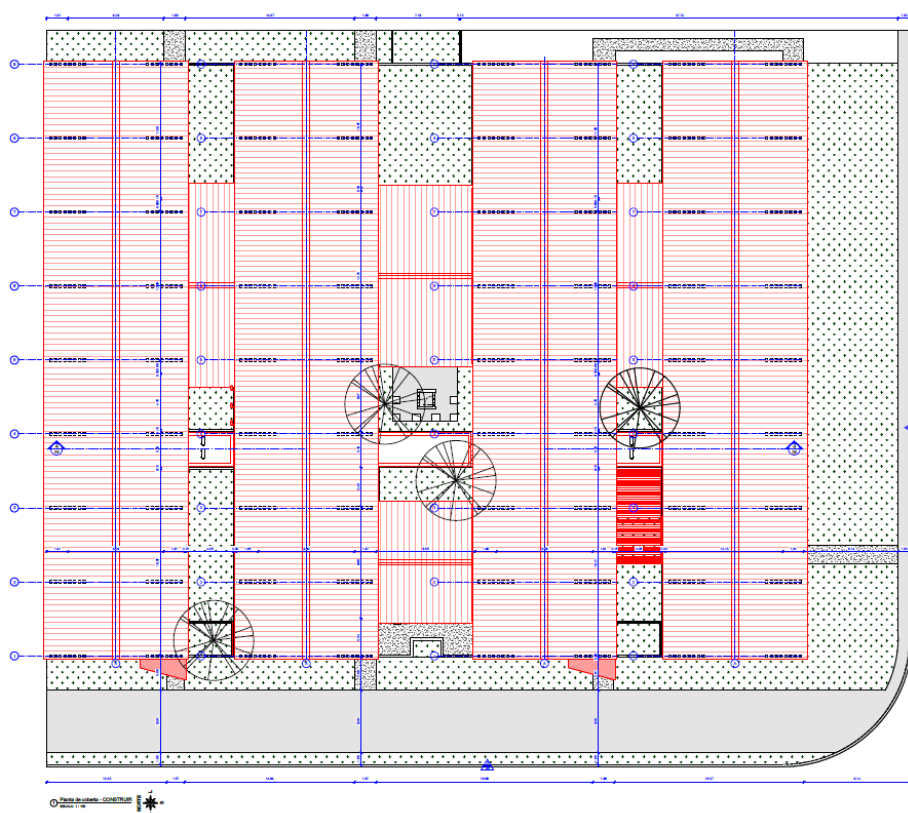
Planta de cobertura. Fonte: O autor, 2024.
